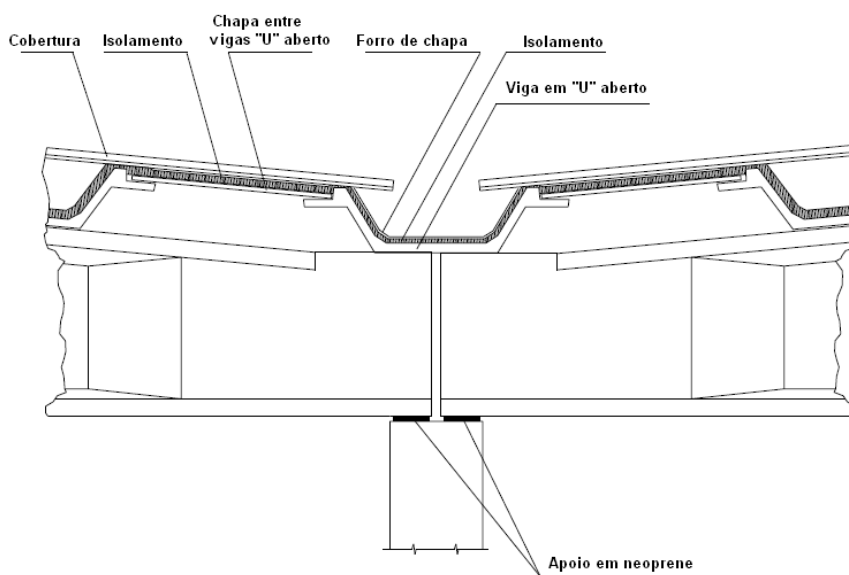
Vigas em “U” aberto, zona de ligação de vigas delta (Painsa, 2013)
